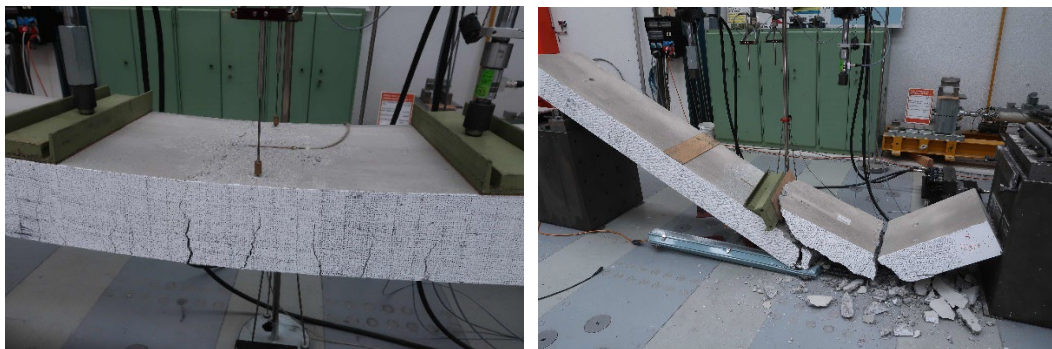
Links: Betonstauchen in Plattenmitte bei Platte 1. Rechts: vollständiger Schubbruch der Platte 3.
